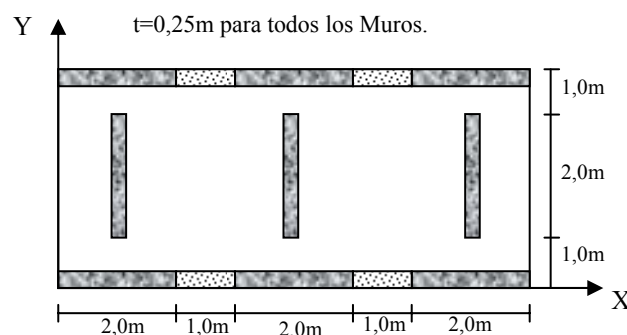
(a) Geometría en Planta, ejemplo 1.
